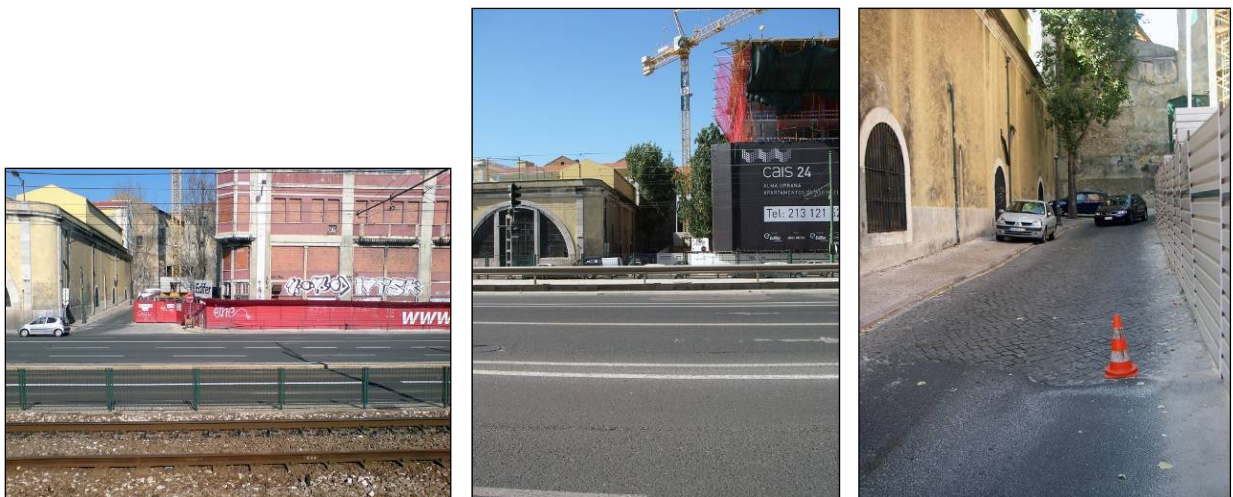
Vista geral do local de implantação do poço final da obra de perfuração horizontal.
